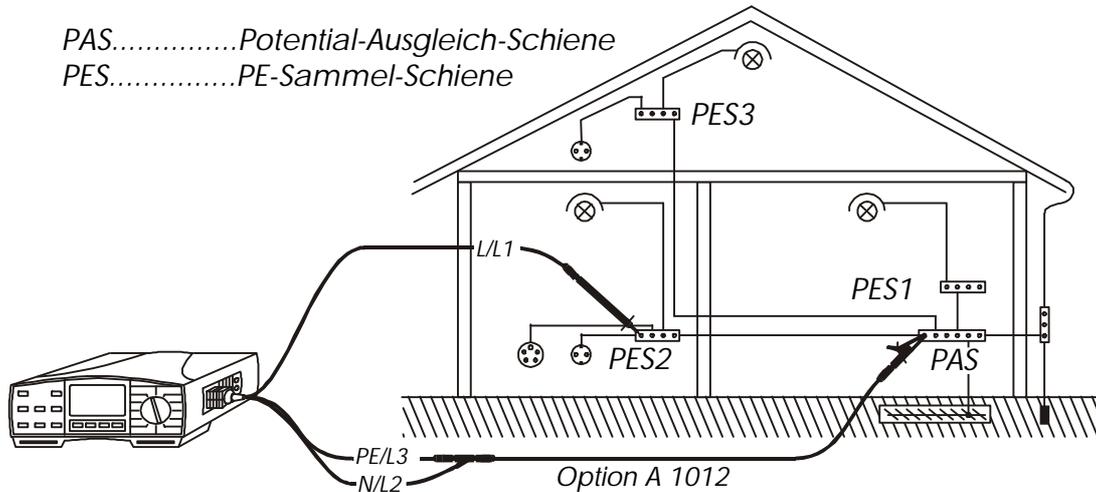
Anschlusskizze für die Niederohmprüfung mit Universellem Prüfkabel und nach Bedarf zusätzlicher Prüfkabelverlängerung (4 m) (Best.-Nr. A 1012)
